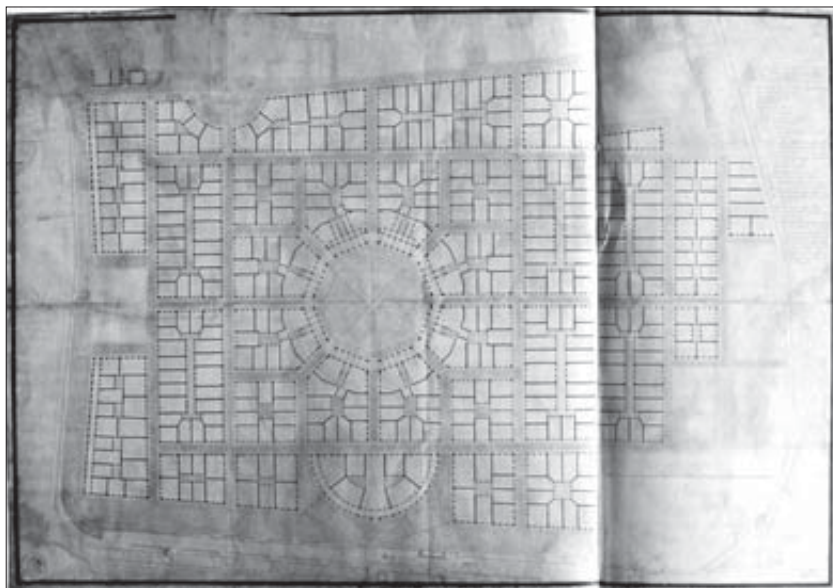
PLAN DE UGARTEMENDÍA (10.1) para la reconstrucción de la ciudad de San Sebastián. 28 de mayo de 1814. Una joya que resultó inalcanzable. Museo de San Telmo.
